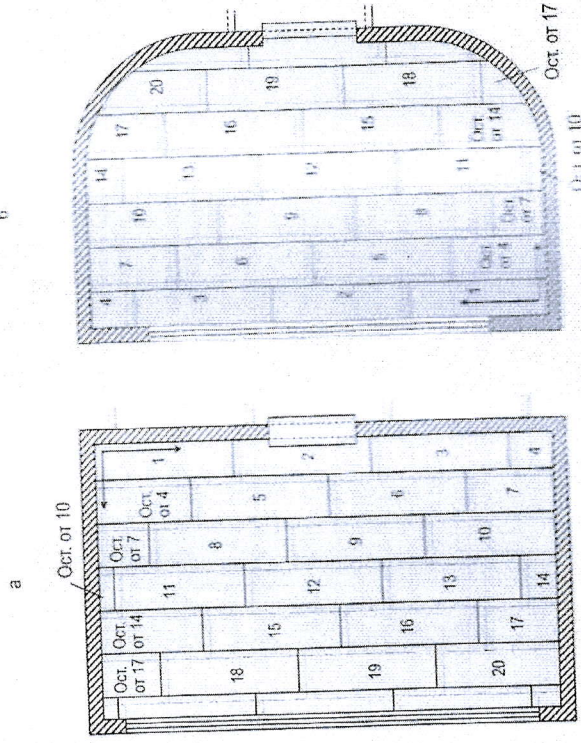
Схемы раскладки элементов пола при укладке от стены с дверным проемом (а) и при укладке от стены противоположной дверному проему (б)
